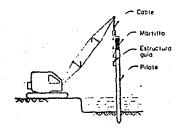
A.4.-PILOTE HINCADO CON GUIA
